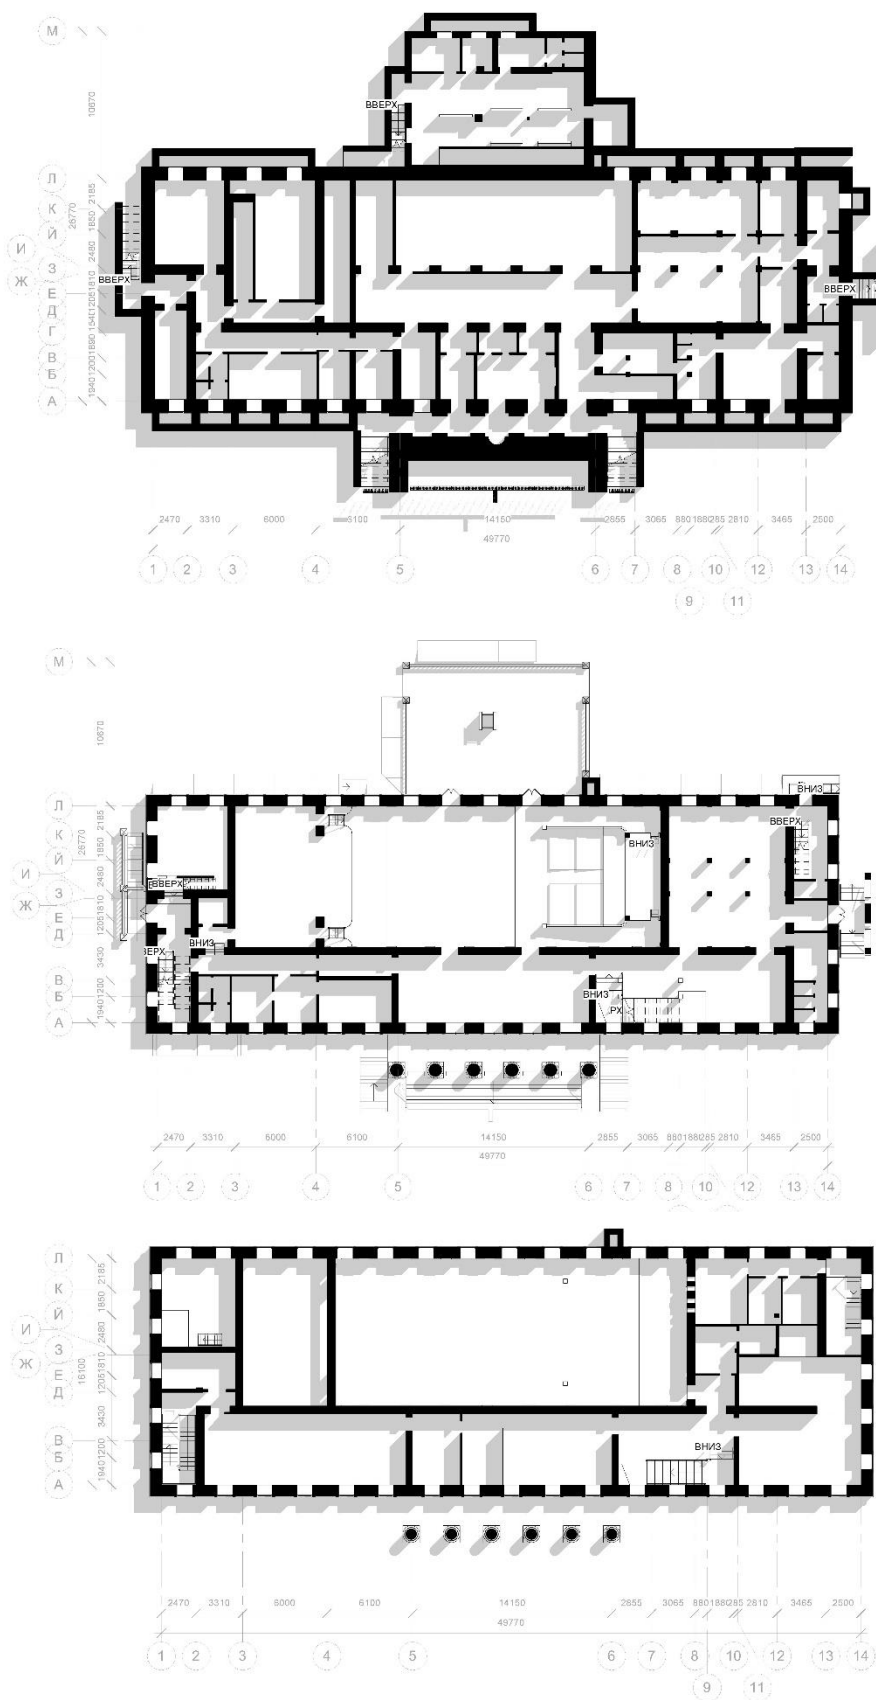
Будівля Дому Офіцерів Флоту (Планування поверхів)
